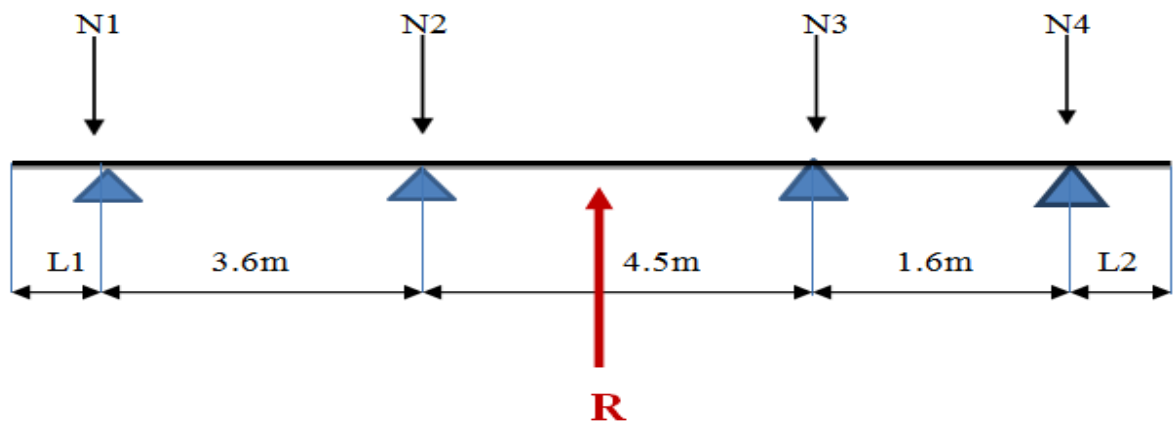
schéma d' une Semelle continue sous quatre poteaux.
